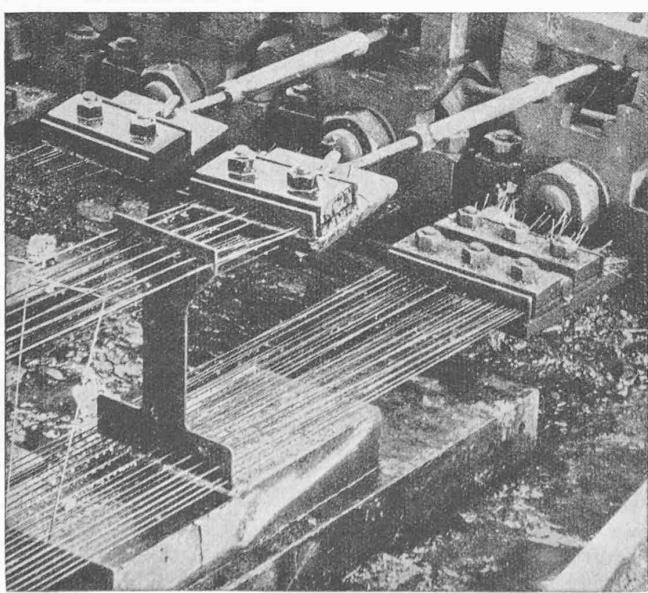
Beispiele von Bauten der Gruppe a): Anspannen der stählernen Zugglieder nach dem Betonieren
